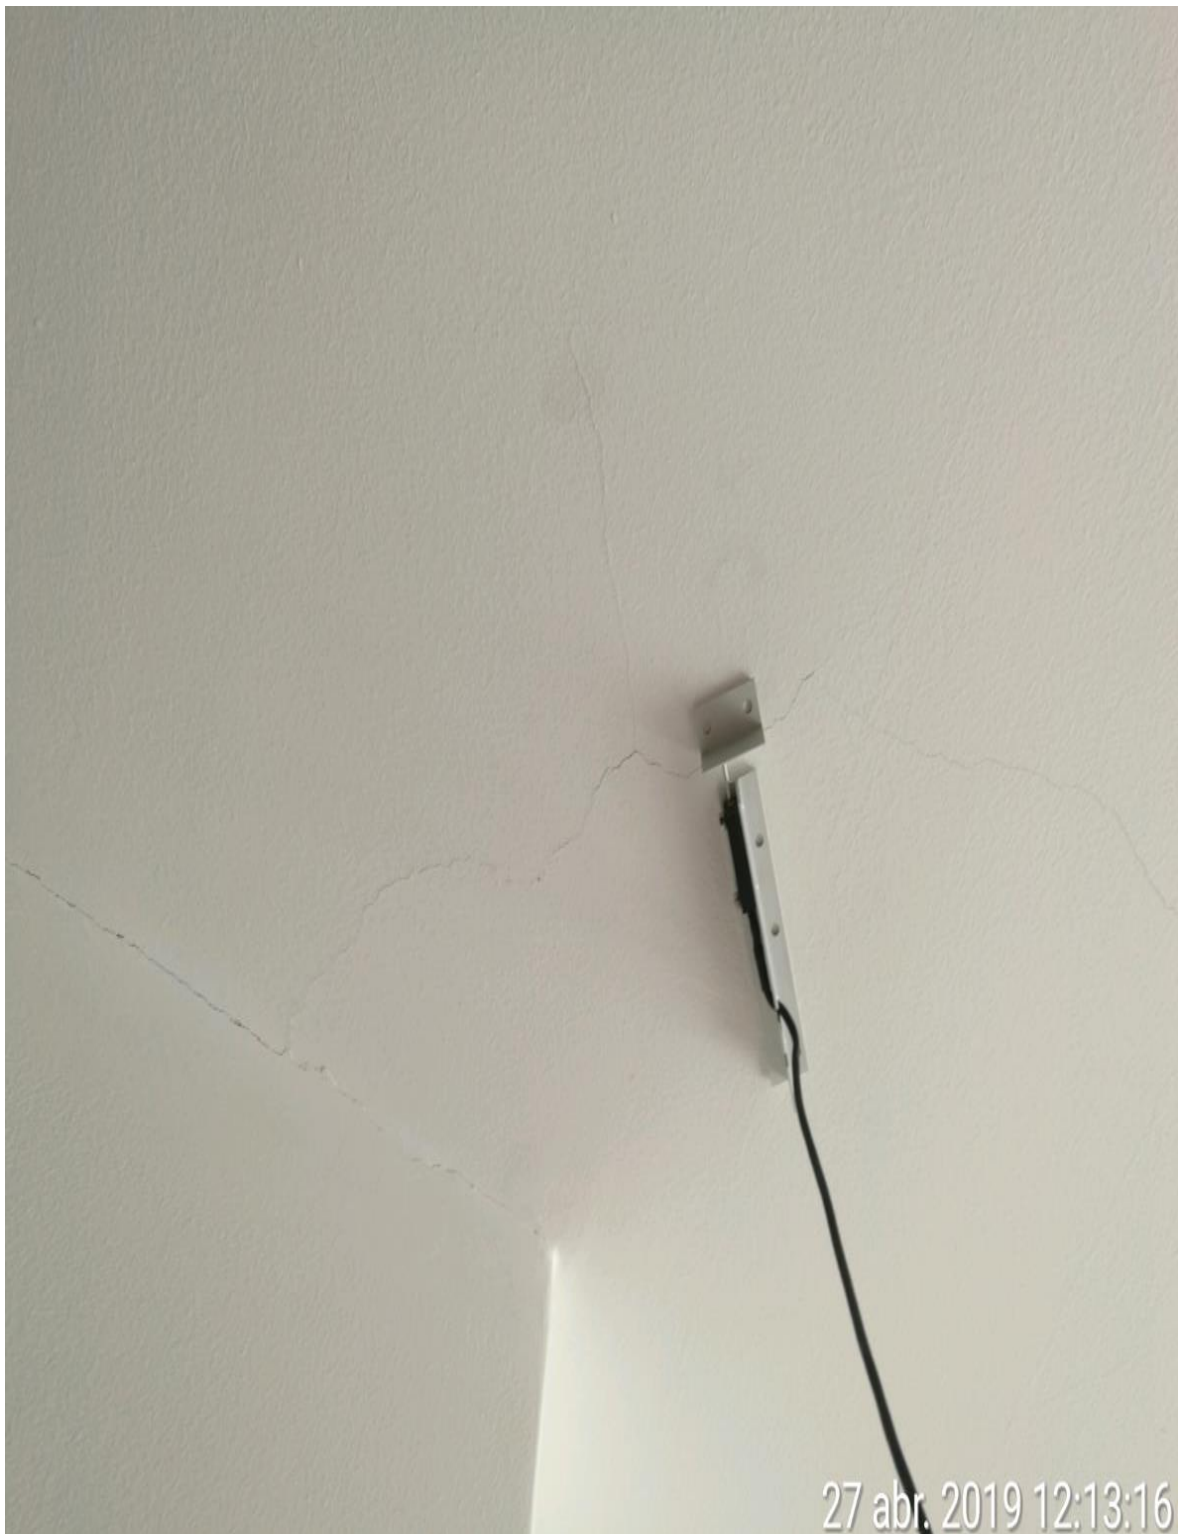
Fisura en Pared en Dormitorio 02, Departamento 502
